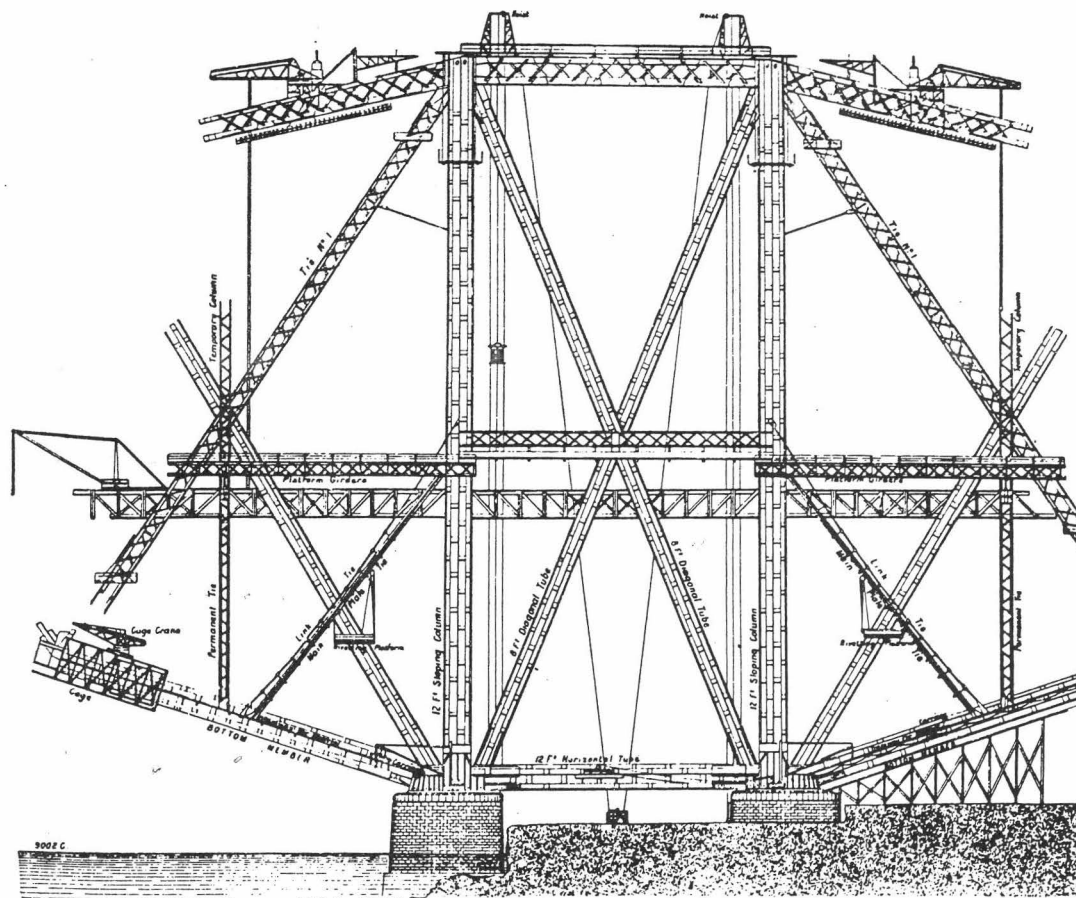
Un voladizo del Puente Forth en proceso de construcción (de W. Westhofen, *The Forth Bridge*, Londres, 1890, p. 53).
